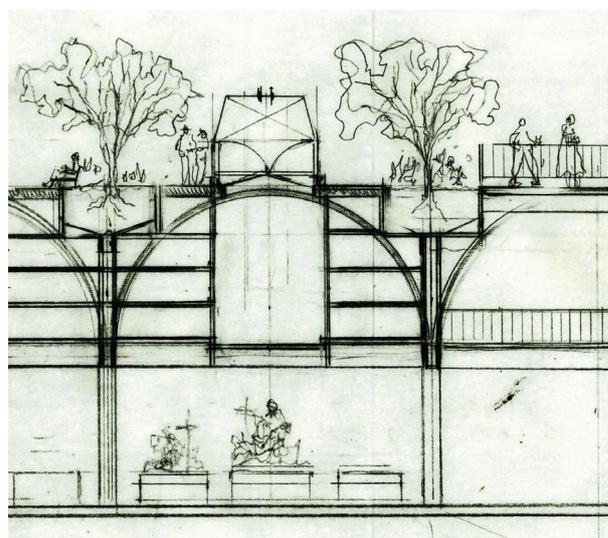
| Detalhe de corte do cemitério vertical do Campo Santo, projeto de Rebouças (1993-94)
